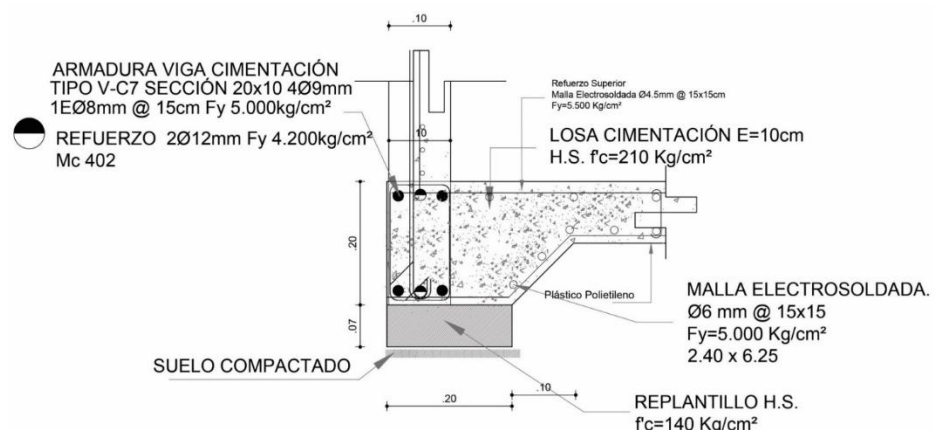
Viga de Cimentación en lindero. (Duque, 2016).
